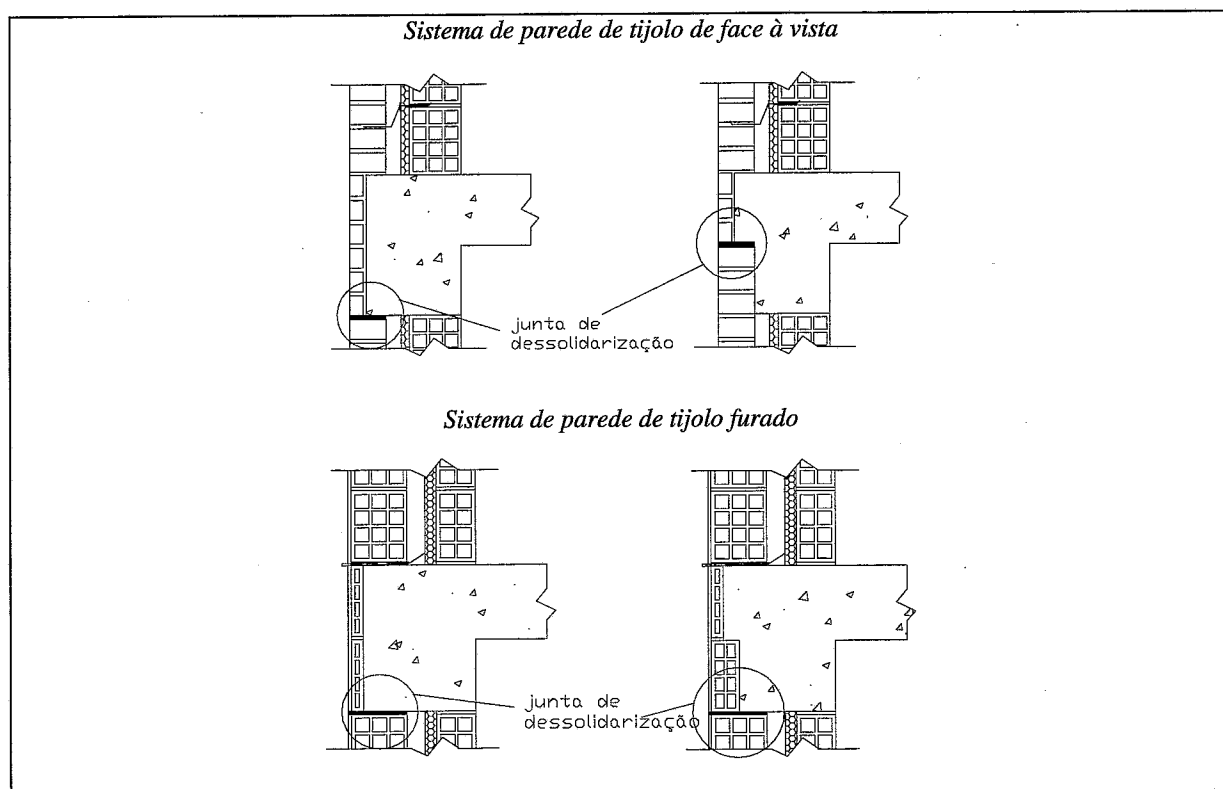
Pormenor da junta de dessolidarização em zona de ligação entre parede e laje/viga em panos com forras cerâmicas
